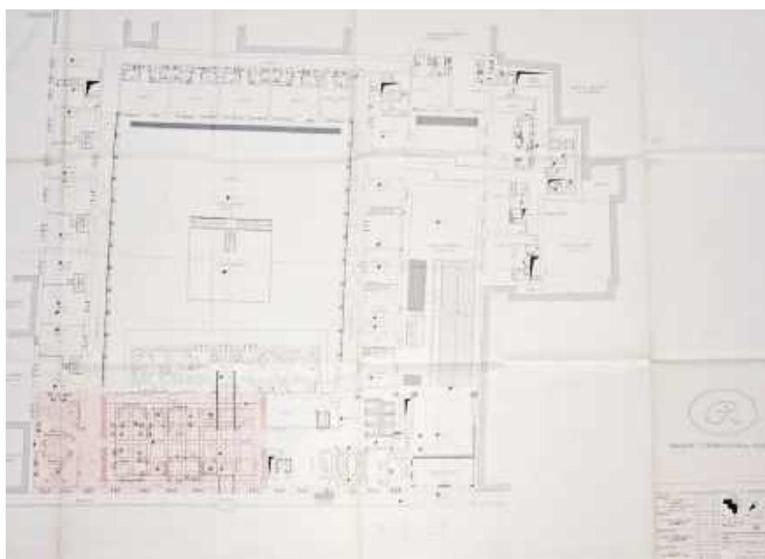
Pianta piano terreno, progetto di restauro e riuso (rosso-chiesa antica e colonne riportate a vista); tavola su carta
